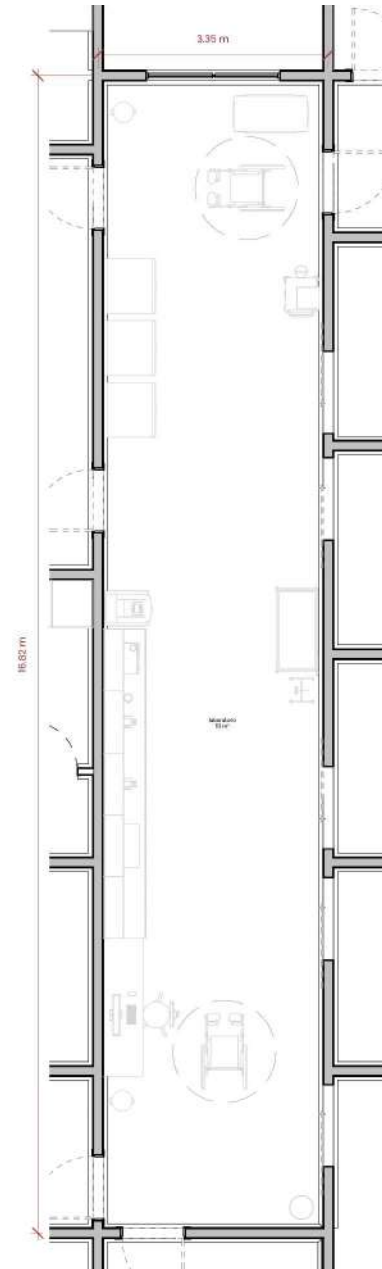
Detalle de laboratorio. Fuente: Elaboración propia
